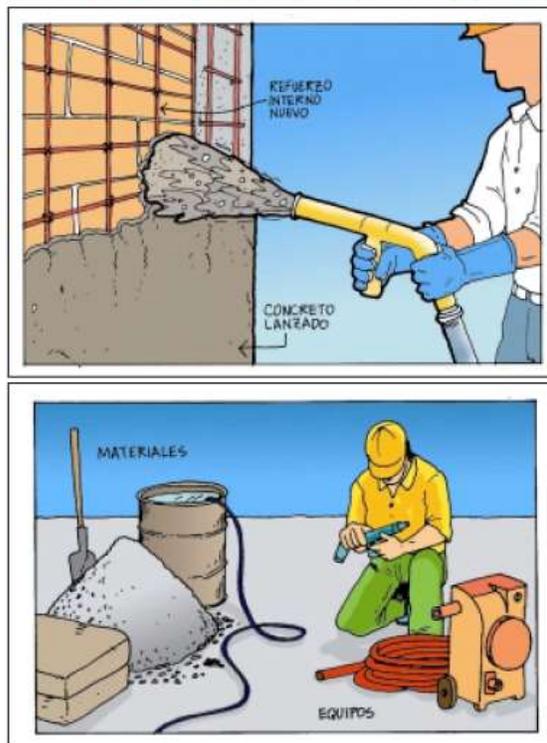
Recomendaciones para el reforzamiento con concreto reforzado (Descripción y Materiales). Fuente Manual AIS de reforzamiento de viviendas en mampostería
